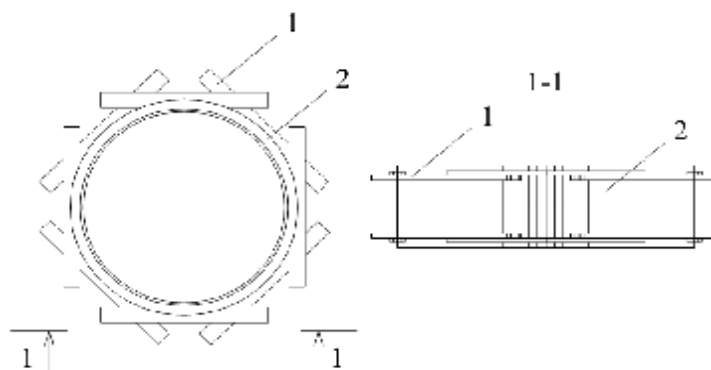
Опалубка круглого сечения для отдельных фундаментов: 1 - стяжные элементы, 2 - полимерная труба
